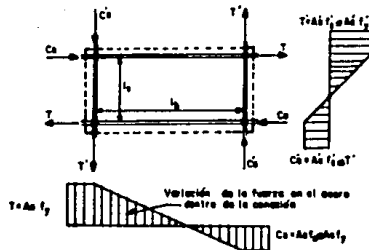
Fuerzas que actúan en el acero de refuerzo del núcleo de la conexión.
